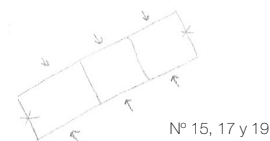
Bocetos en planta de la disposición de las construcciones situadas en la Rúa Moaña-Coia, nº 15, 17 y 19 (autoría propia).
